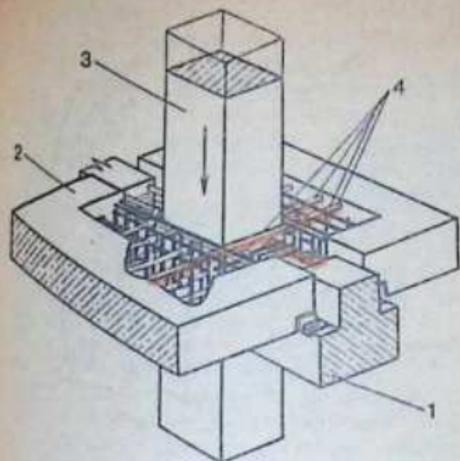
Узел сопряжения связевых плит с колоннами и ригелем (каркас многоэтажного здания для строительства в сейсмических районах):
